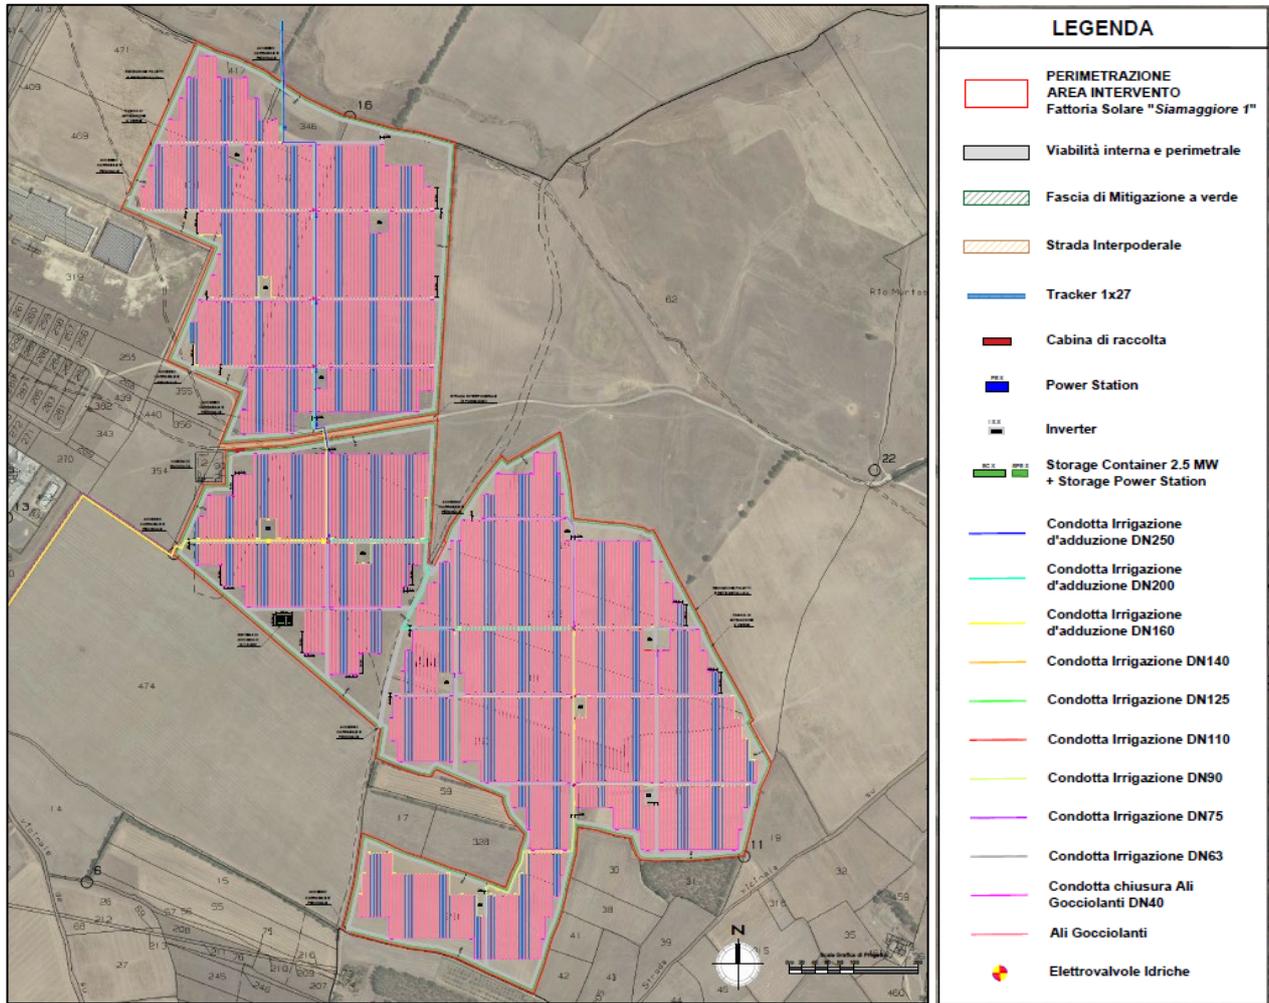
Layout Impianto di Irrigazione/Fertirrigazione
